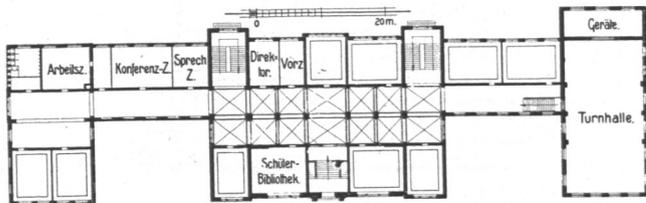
Realgymnasium Armgartstraße, Erdgeschoss.
